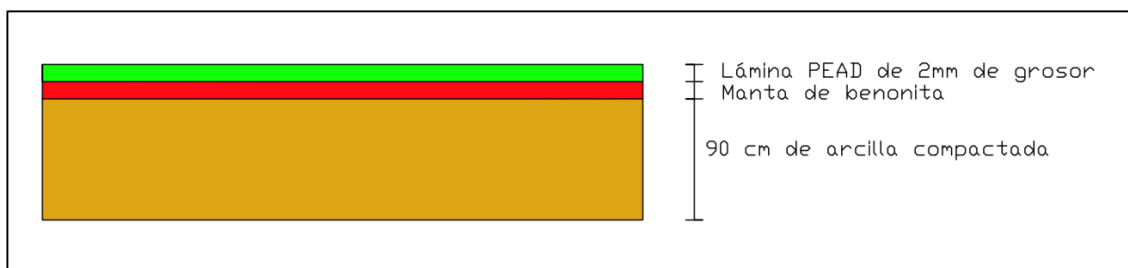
Sección capa impermeabilizante con barrera mineral natural (BMN). Fuente: Elaboración propia
